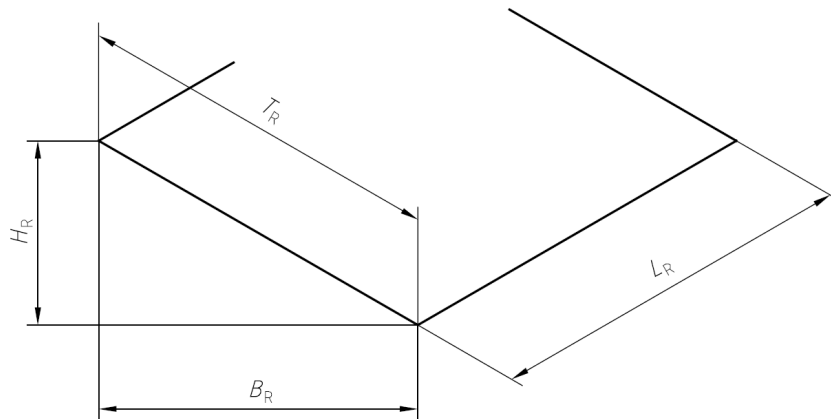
Dimensões do telhado (fonte:(EN 12056-3, 2000))
